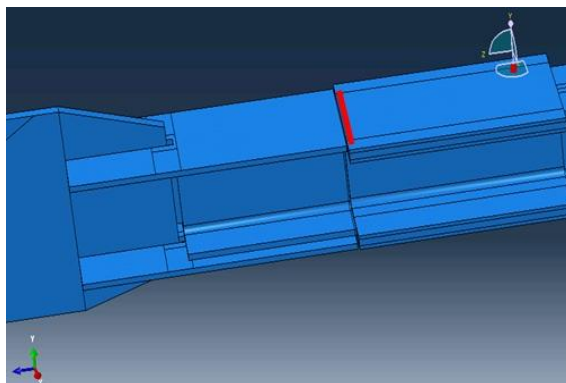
Soudure de la plaque extérieure sur les semelles du côté de l'assemblage
